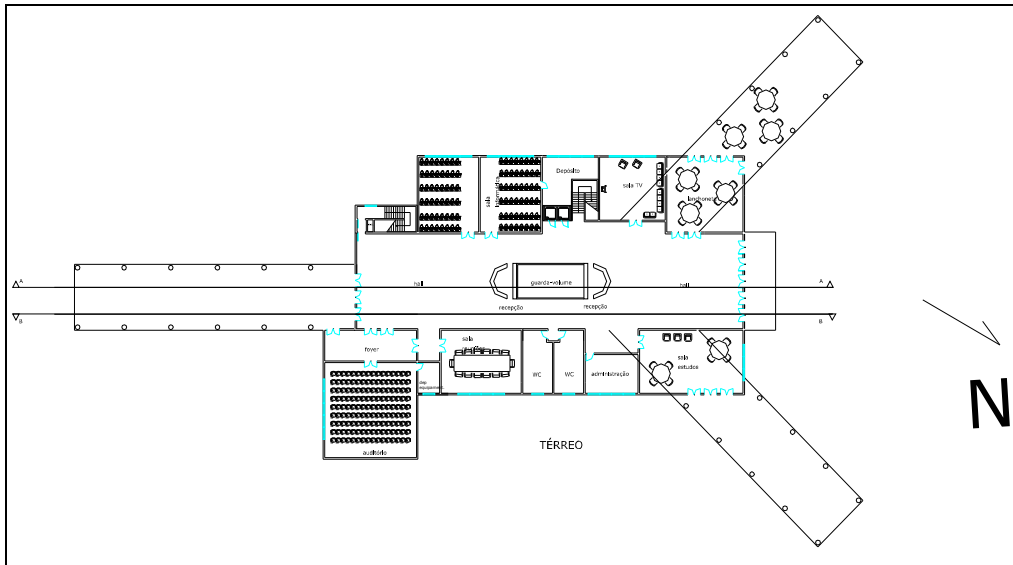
Planta do pavimento térreo do Projeto "B" (s/esc.).
